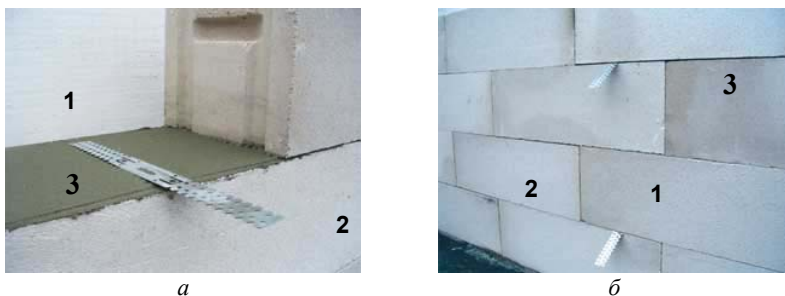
Крепление перегородок к несущей стене стальными анкерами:
